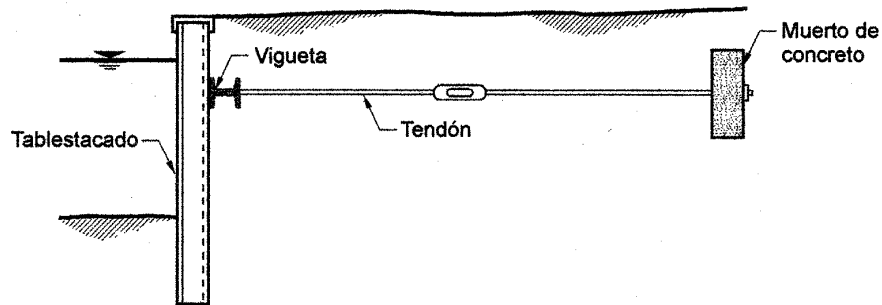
, Tablestacado anclado con un muerto de concreto
